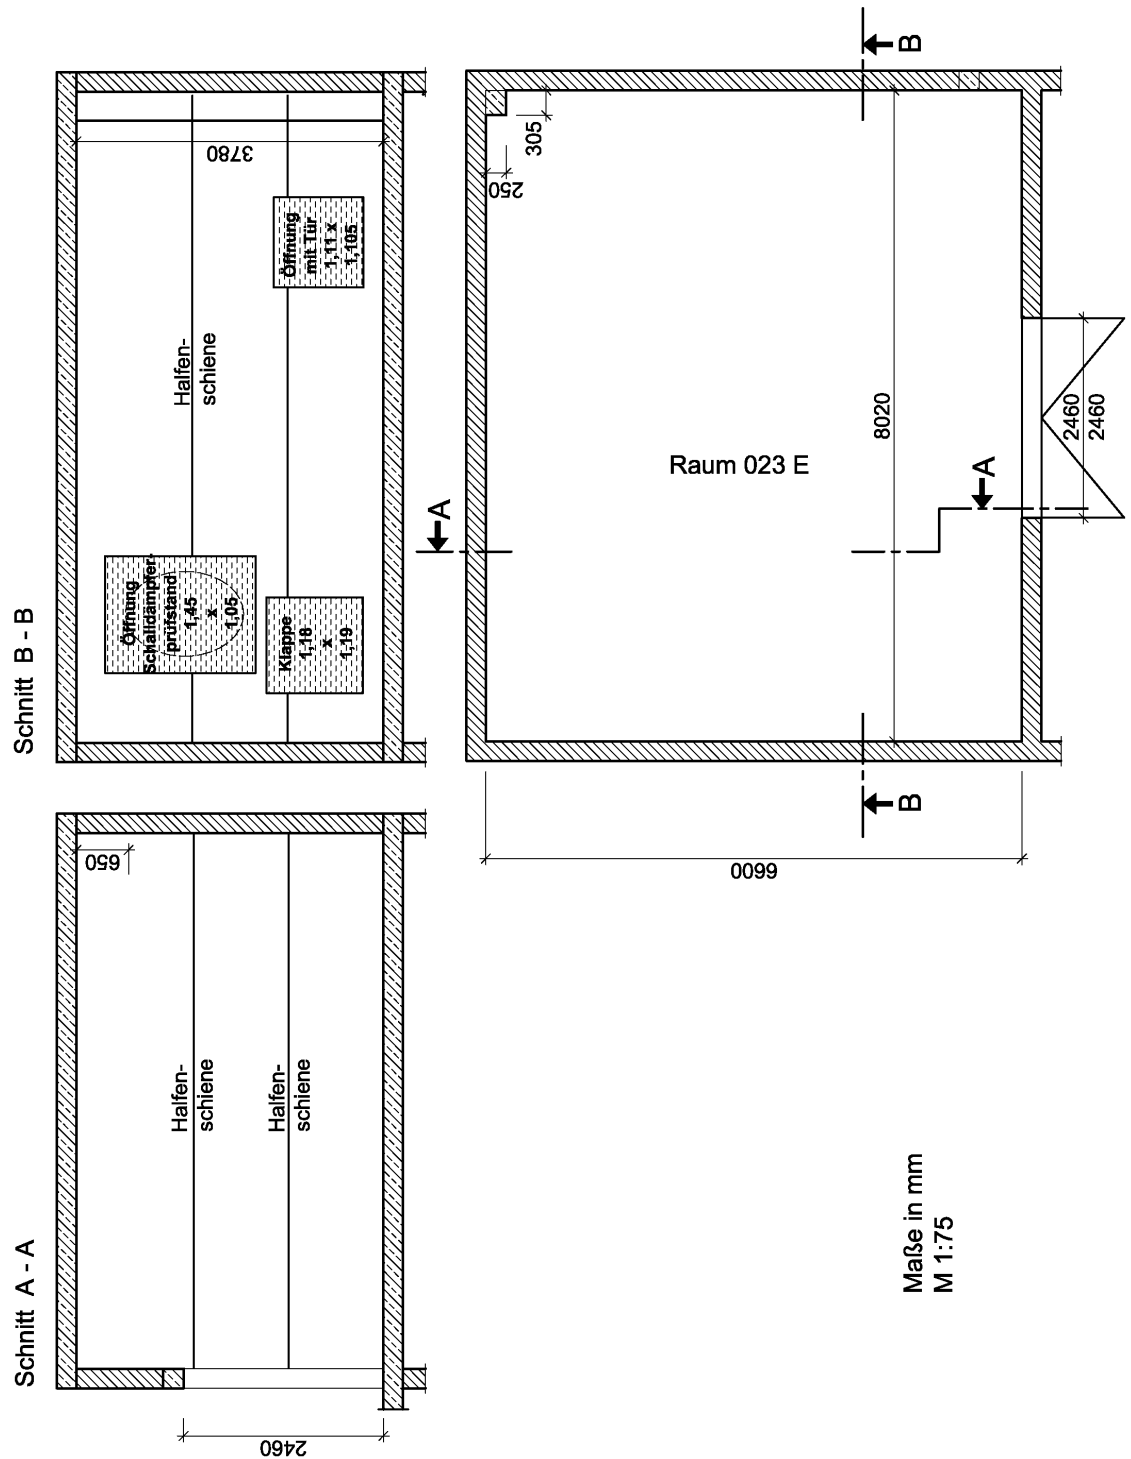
Grundriss und Schnitte des Hallraums nach ISO 354
